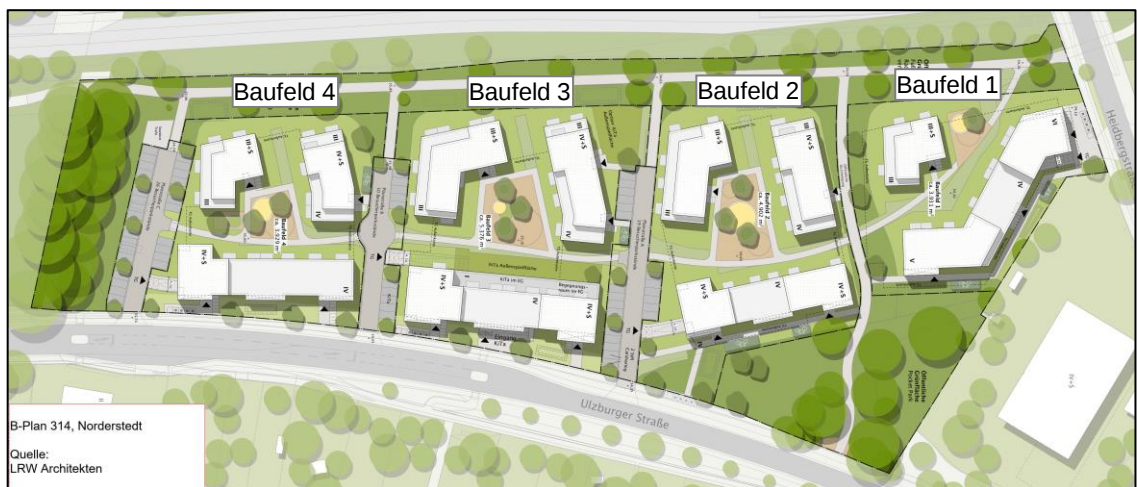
Geplante Bebauung für den Bebauungsplan 314 in Norderstedt (Quelle: LRW Architekten)
